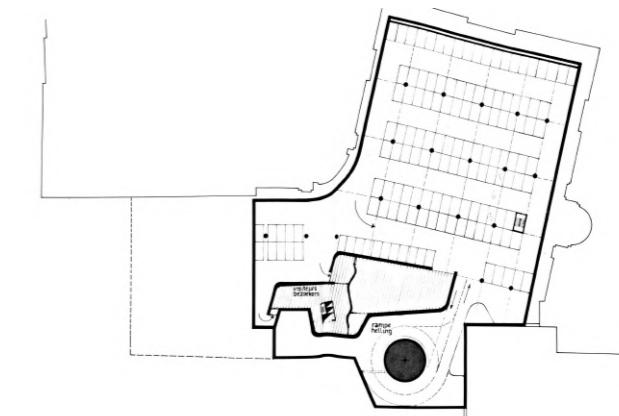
Plan d'un niveau de parking, esquisse définitive.
